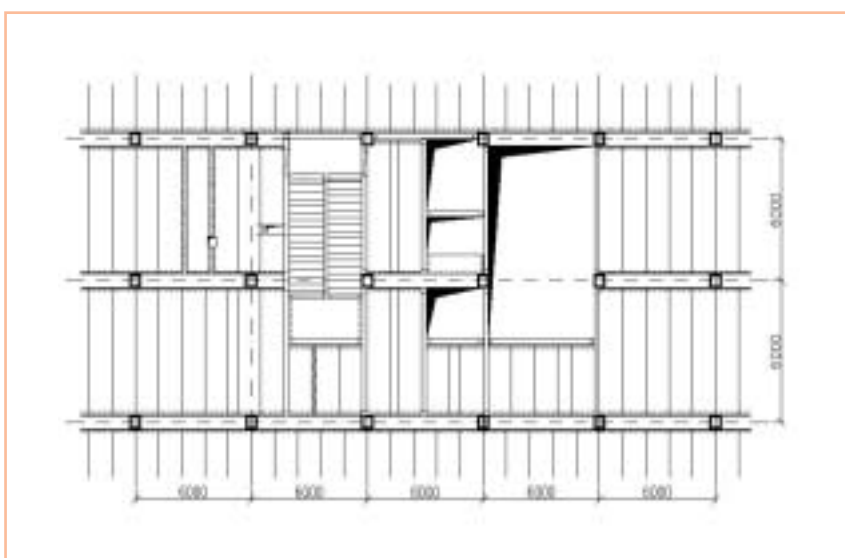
Prefabrikovaný dojezd výtahu zabudovaný ve stropní konstrukci
